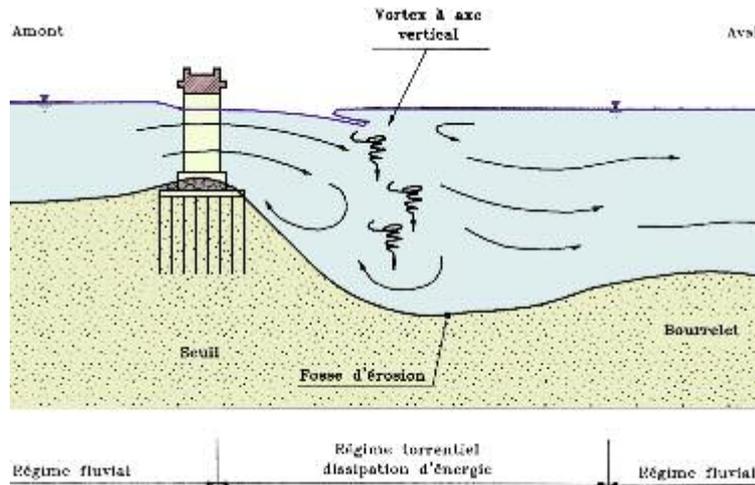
effet de seuil dû aux protections trop larges autour des fondations
